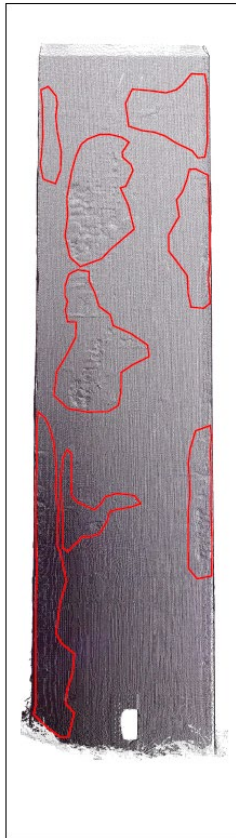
Levantamiento Pila 7 Izquierda – Cara 3
